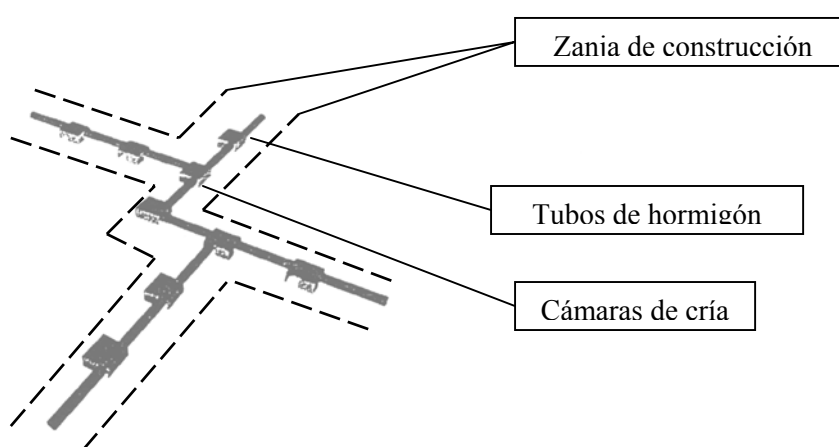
Esquema de la construcción de un vivar de tipo "tubo". Se muestran la disposición de las cámaras de cría de hormigón en las que se unen tubos de hormigón de 1 m., y la colocación de éstos. Las líneas punteadas indican la ubicación de la zanja que debe cavarse previamente a la instalación de los tubos (profundidad = 60 cm.). El conjunto queda totalmente enterrado con las bocas al nivel de la superficie del suelo. (Esquema proporcionado por la Fundación CBD-Hábitat y modificado por el autor).
